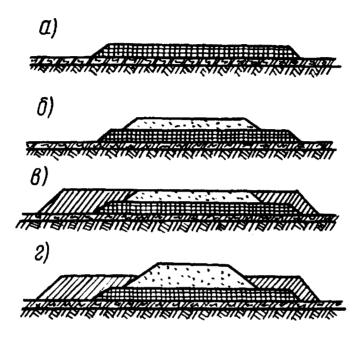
Последовательность возведения земляного полотна с теплоизоляционным слоем в основании присыпными бермами:
